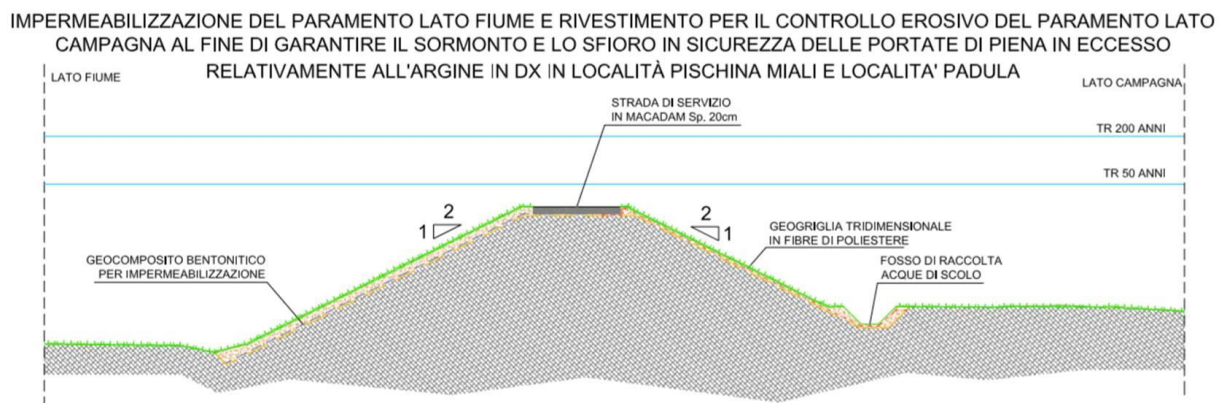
Sezione tipo dell'impermeabilizzazione e rivestimento del lotto funzionale n° 8
